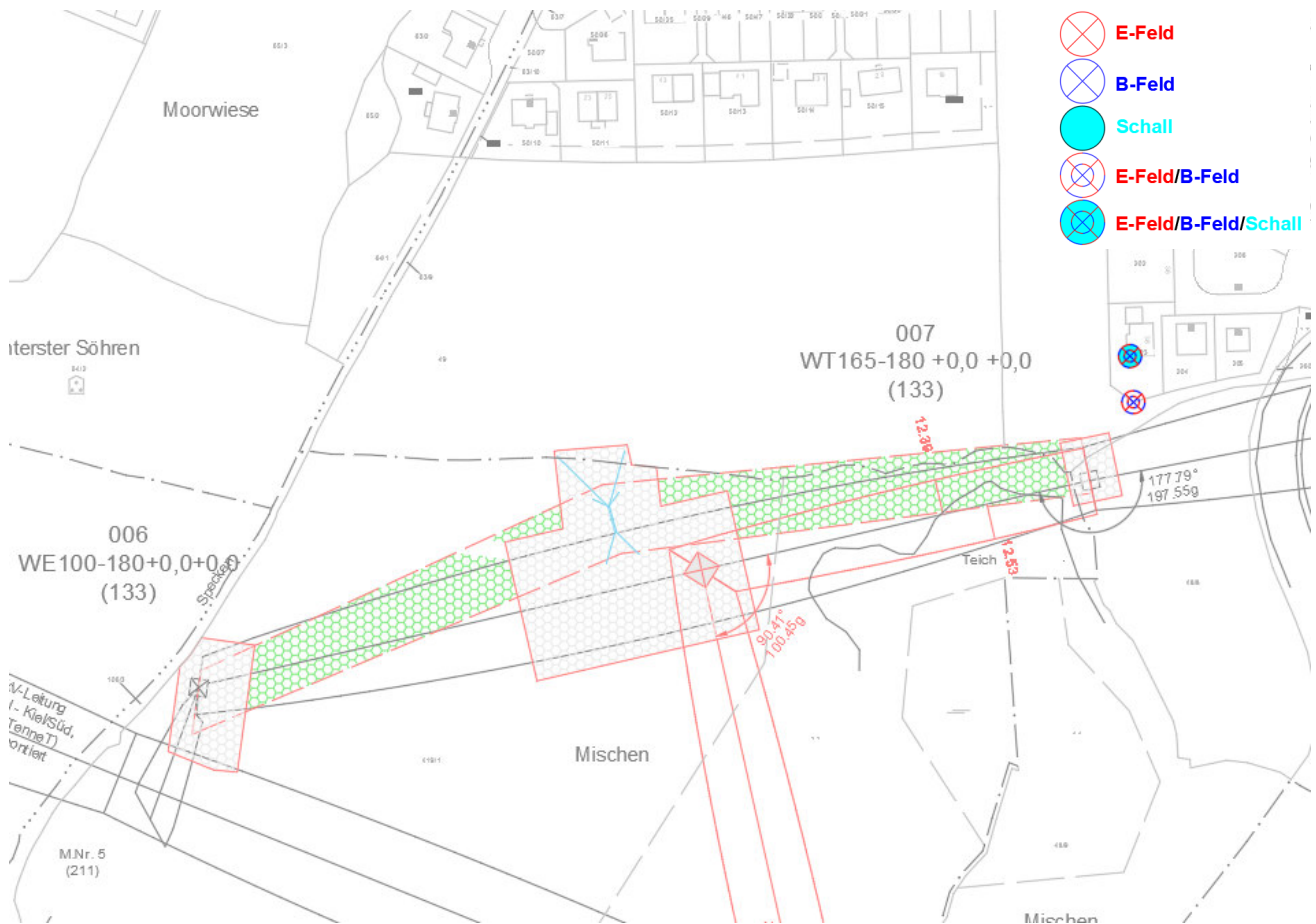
Lageplanausschnitt der Leitung LH-13-202 mit dem Berechnungspunkten
